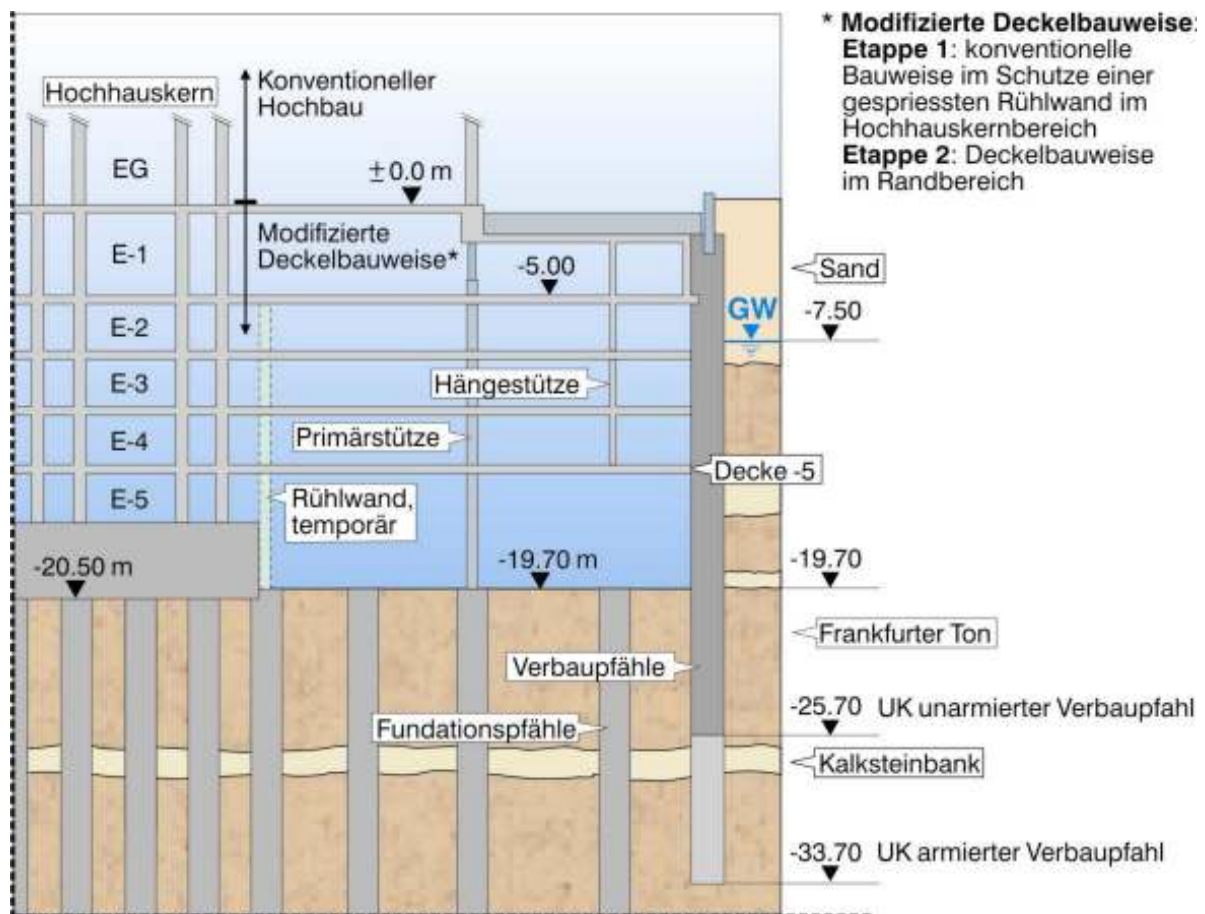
Prinzipialquerschnitt Baugrube Main Tower, modifizierte Deckelbauweise
